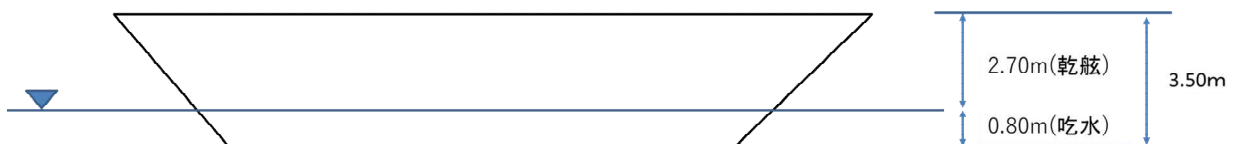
(参考-2) 土運船乾舷確認写真 (空荷状態) イメージ図
